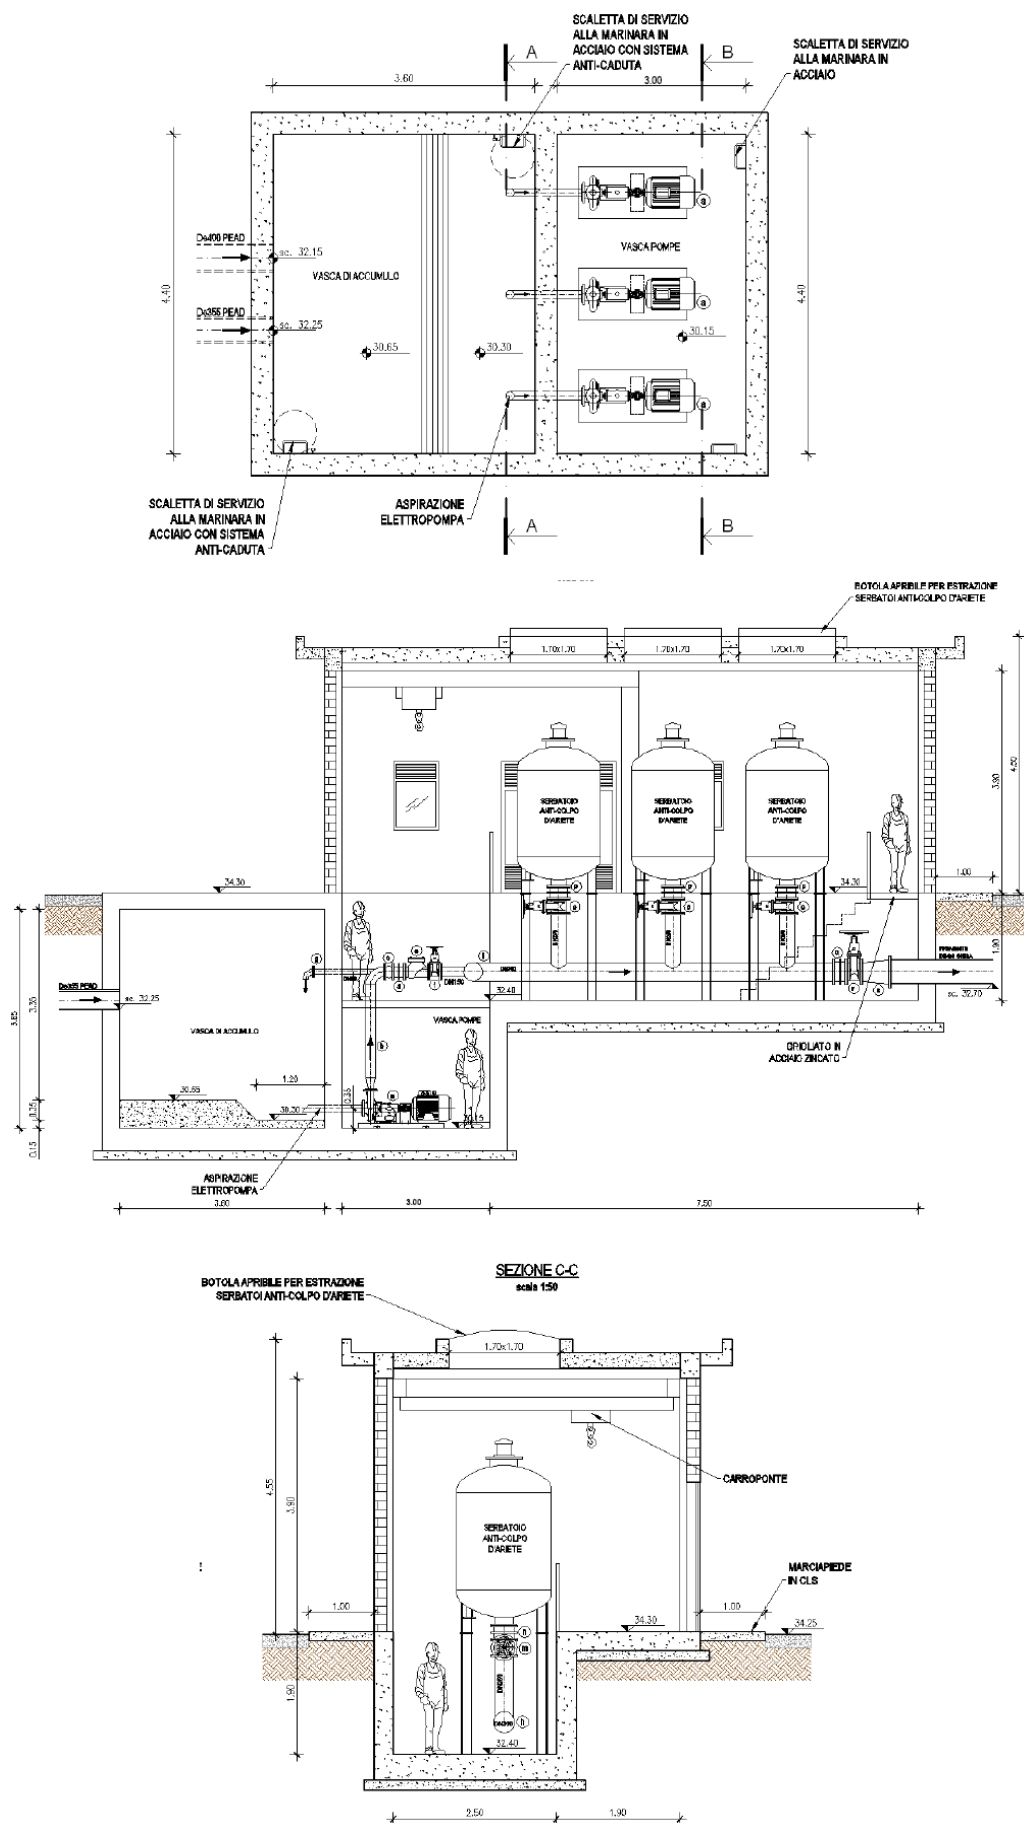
Pianta e sezioni impianto di sollevamento S1
